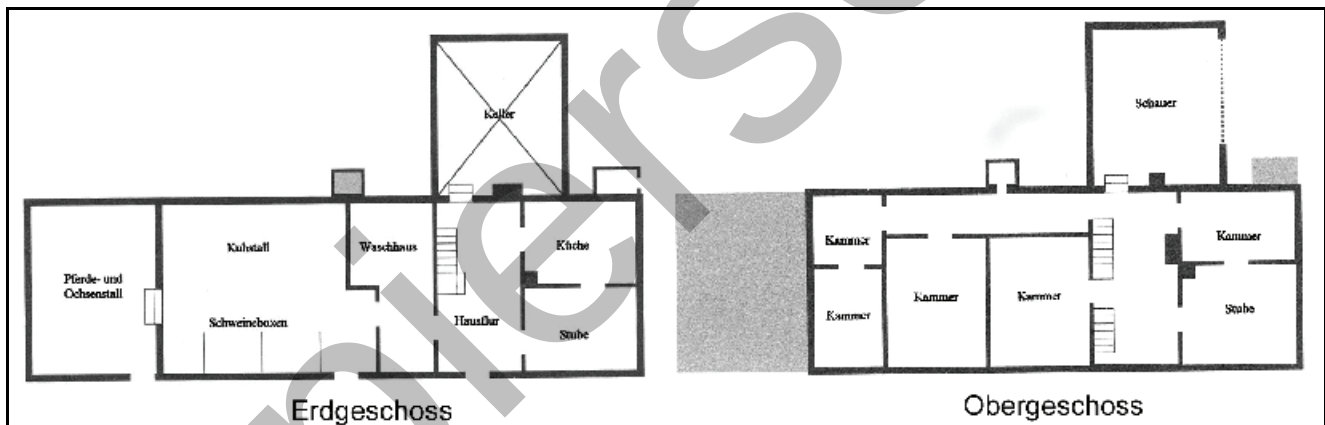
Die Grundrisse vom Erd- und Obergeschoss des Wohnstallhauses. Samml. M. Schröder, Markersb.
